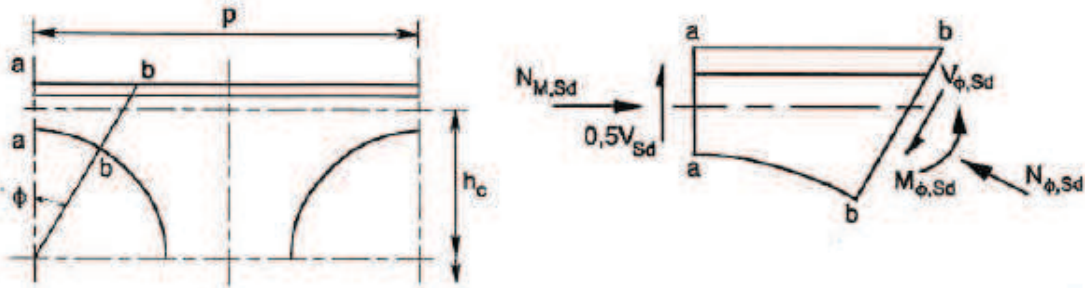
Sollicitations sur une section plane inclinée d'un angle ϕ [6]
